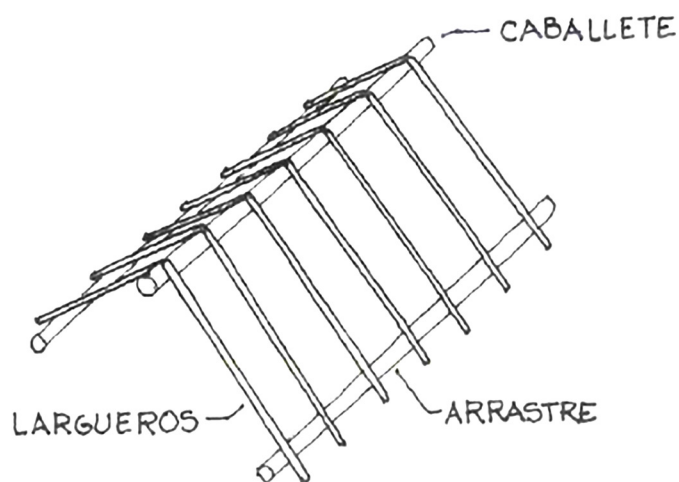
Estructura de Vigas sobre Arrastres Transversales³¹⁷
